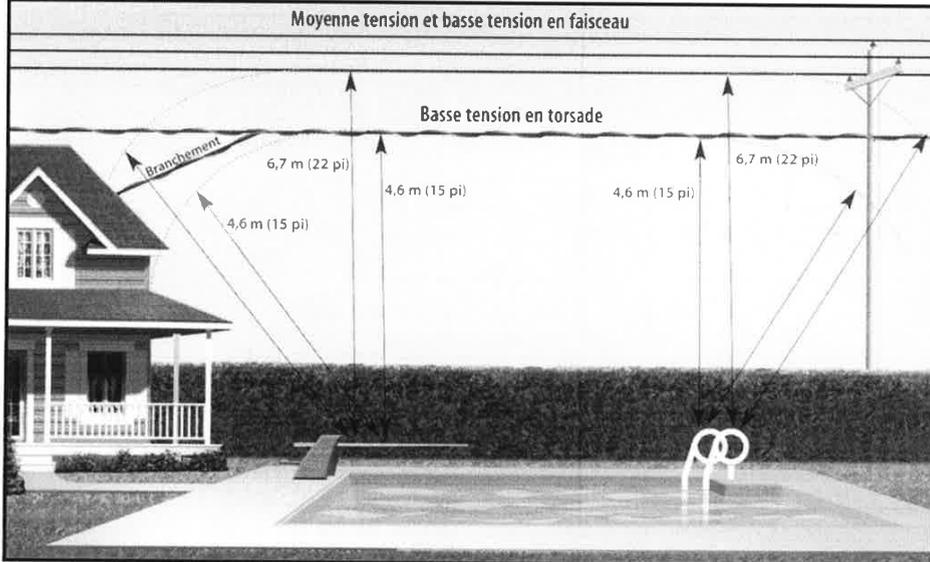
b Dégagement minima entre équipement sur poteau, piscine et accessoires
